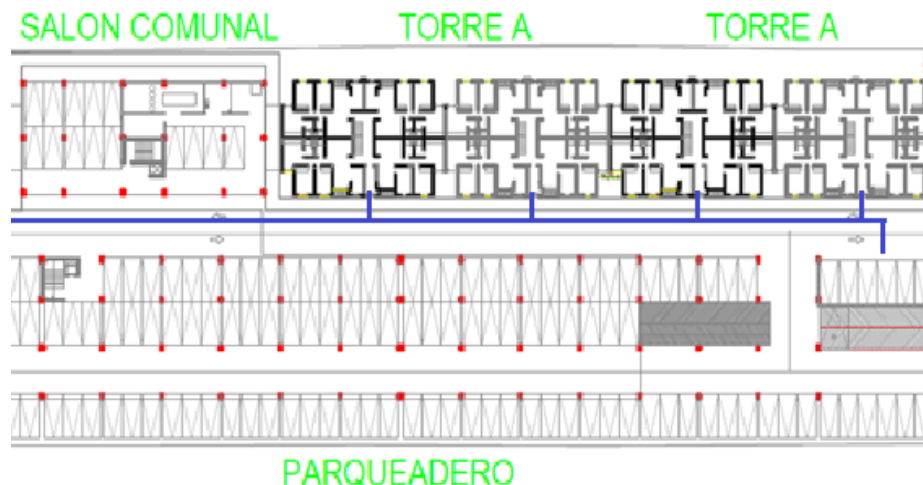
Plano de Implantación Arquitectónica de un Proyecto de Vivienda
